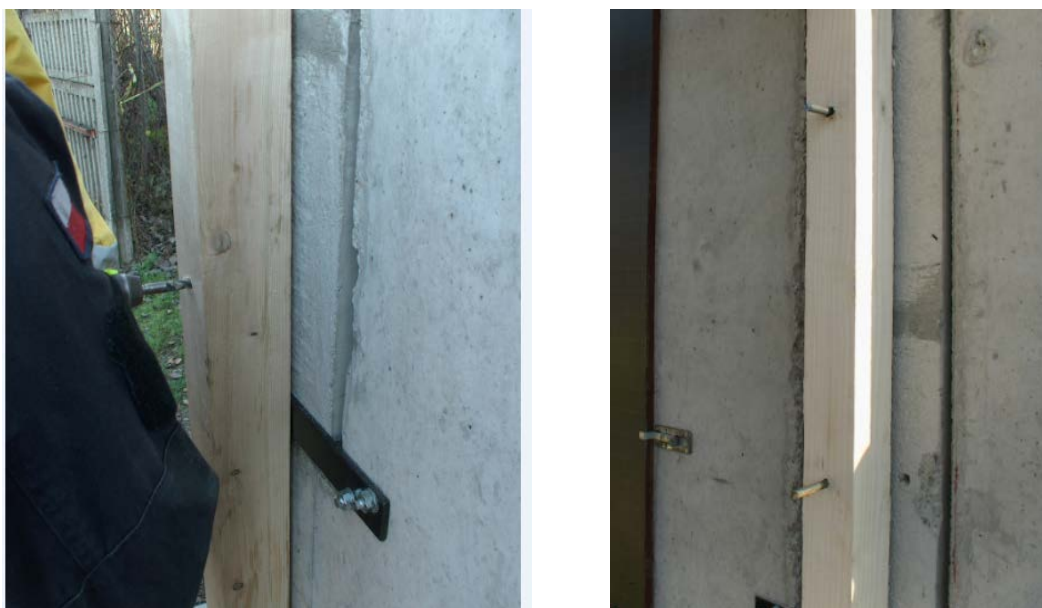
Przygotowany zestaw do montażu podpory ukośnej tymczasowej
